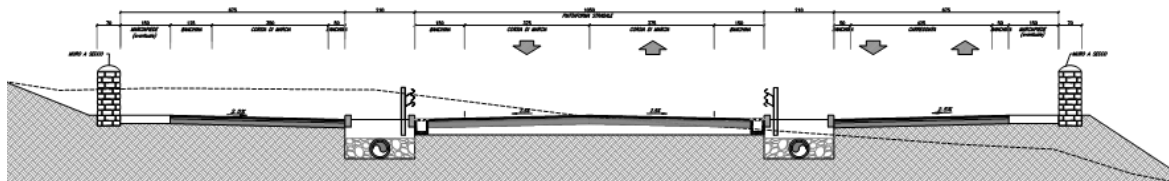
Sezione tipo C1 con stradelle laterali.
